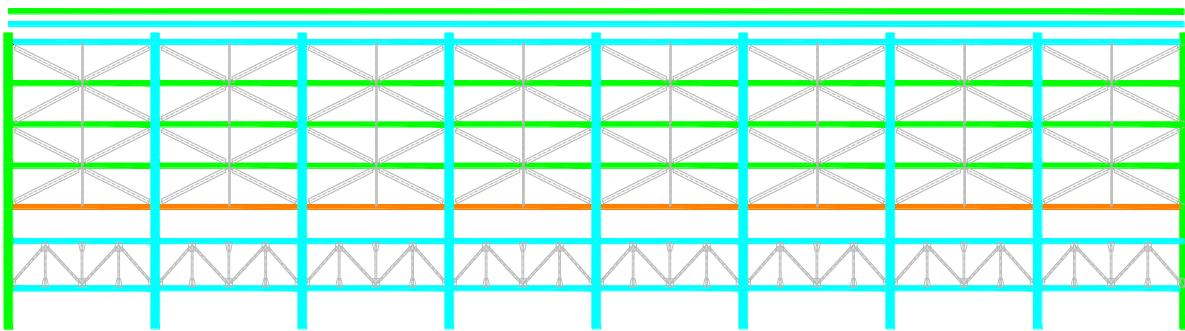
Vista en planta de los largueros del tramo metálico levadizo, se observa el resumen de la revisión de los largueros del tramo levadizo por el criterio LRFD.
